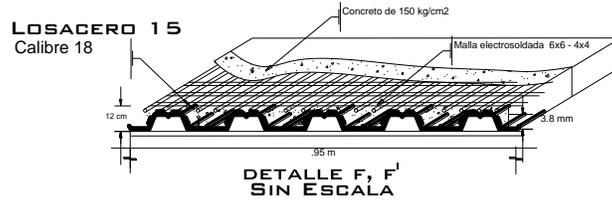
, Detalle losa de cimentación. Diseño: Hugo Orduña.
